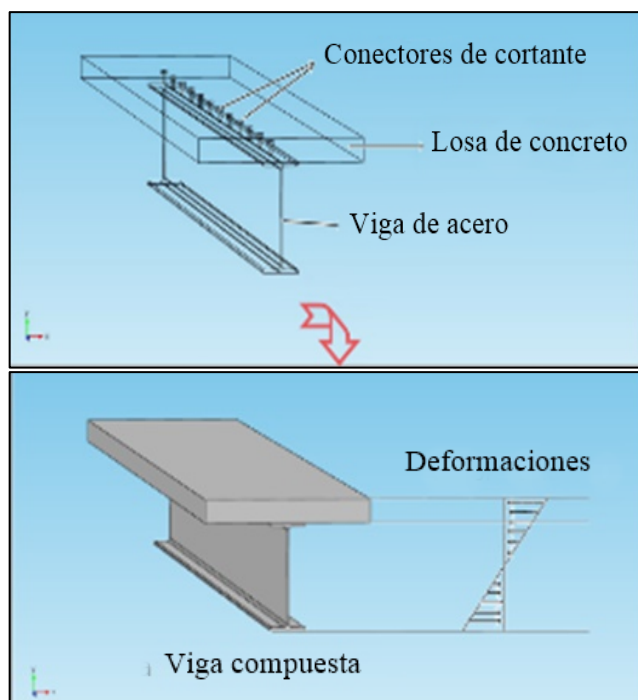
Detalle de vigas compuestas. Fuente: Autor
